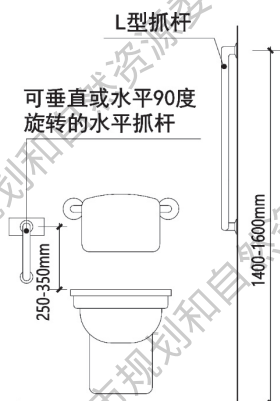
无障碍坐便器 L 型安全抓杆设置正立面图
